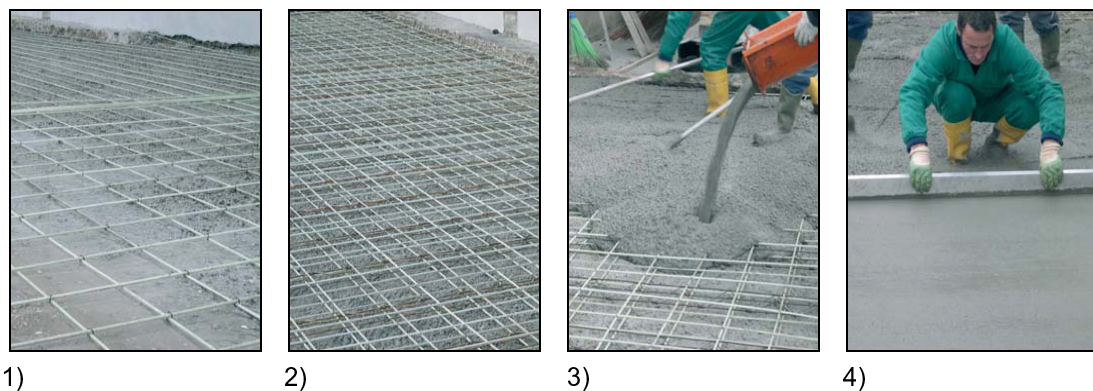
Proceso de armado con FRP de una losa y puesta del hormigón.
